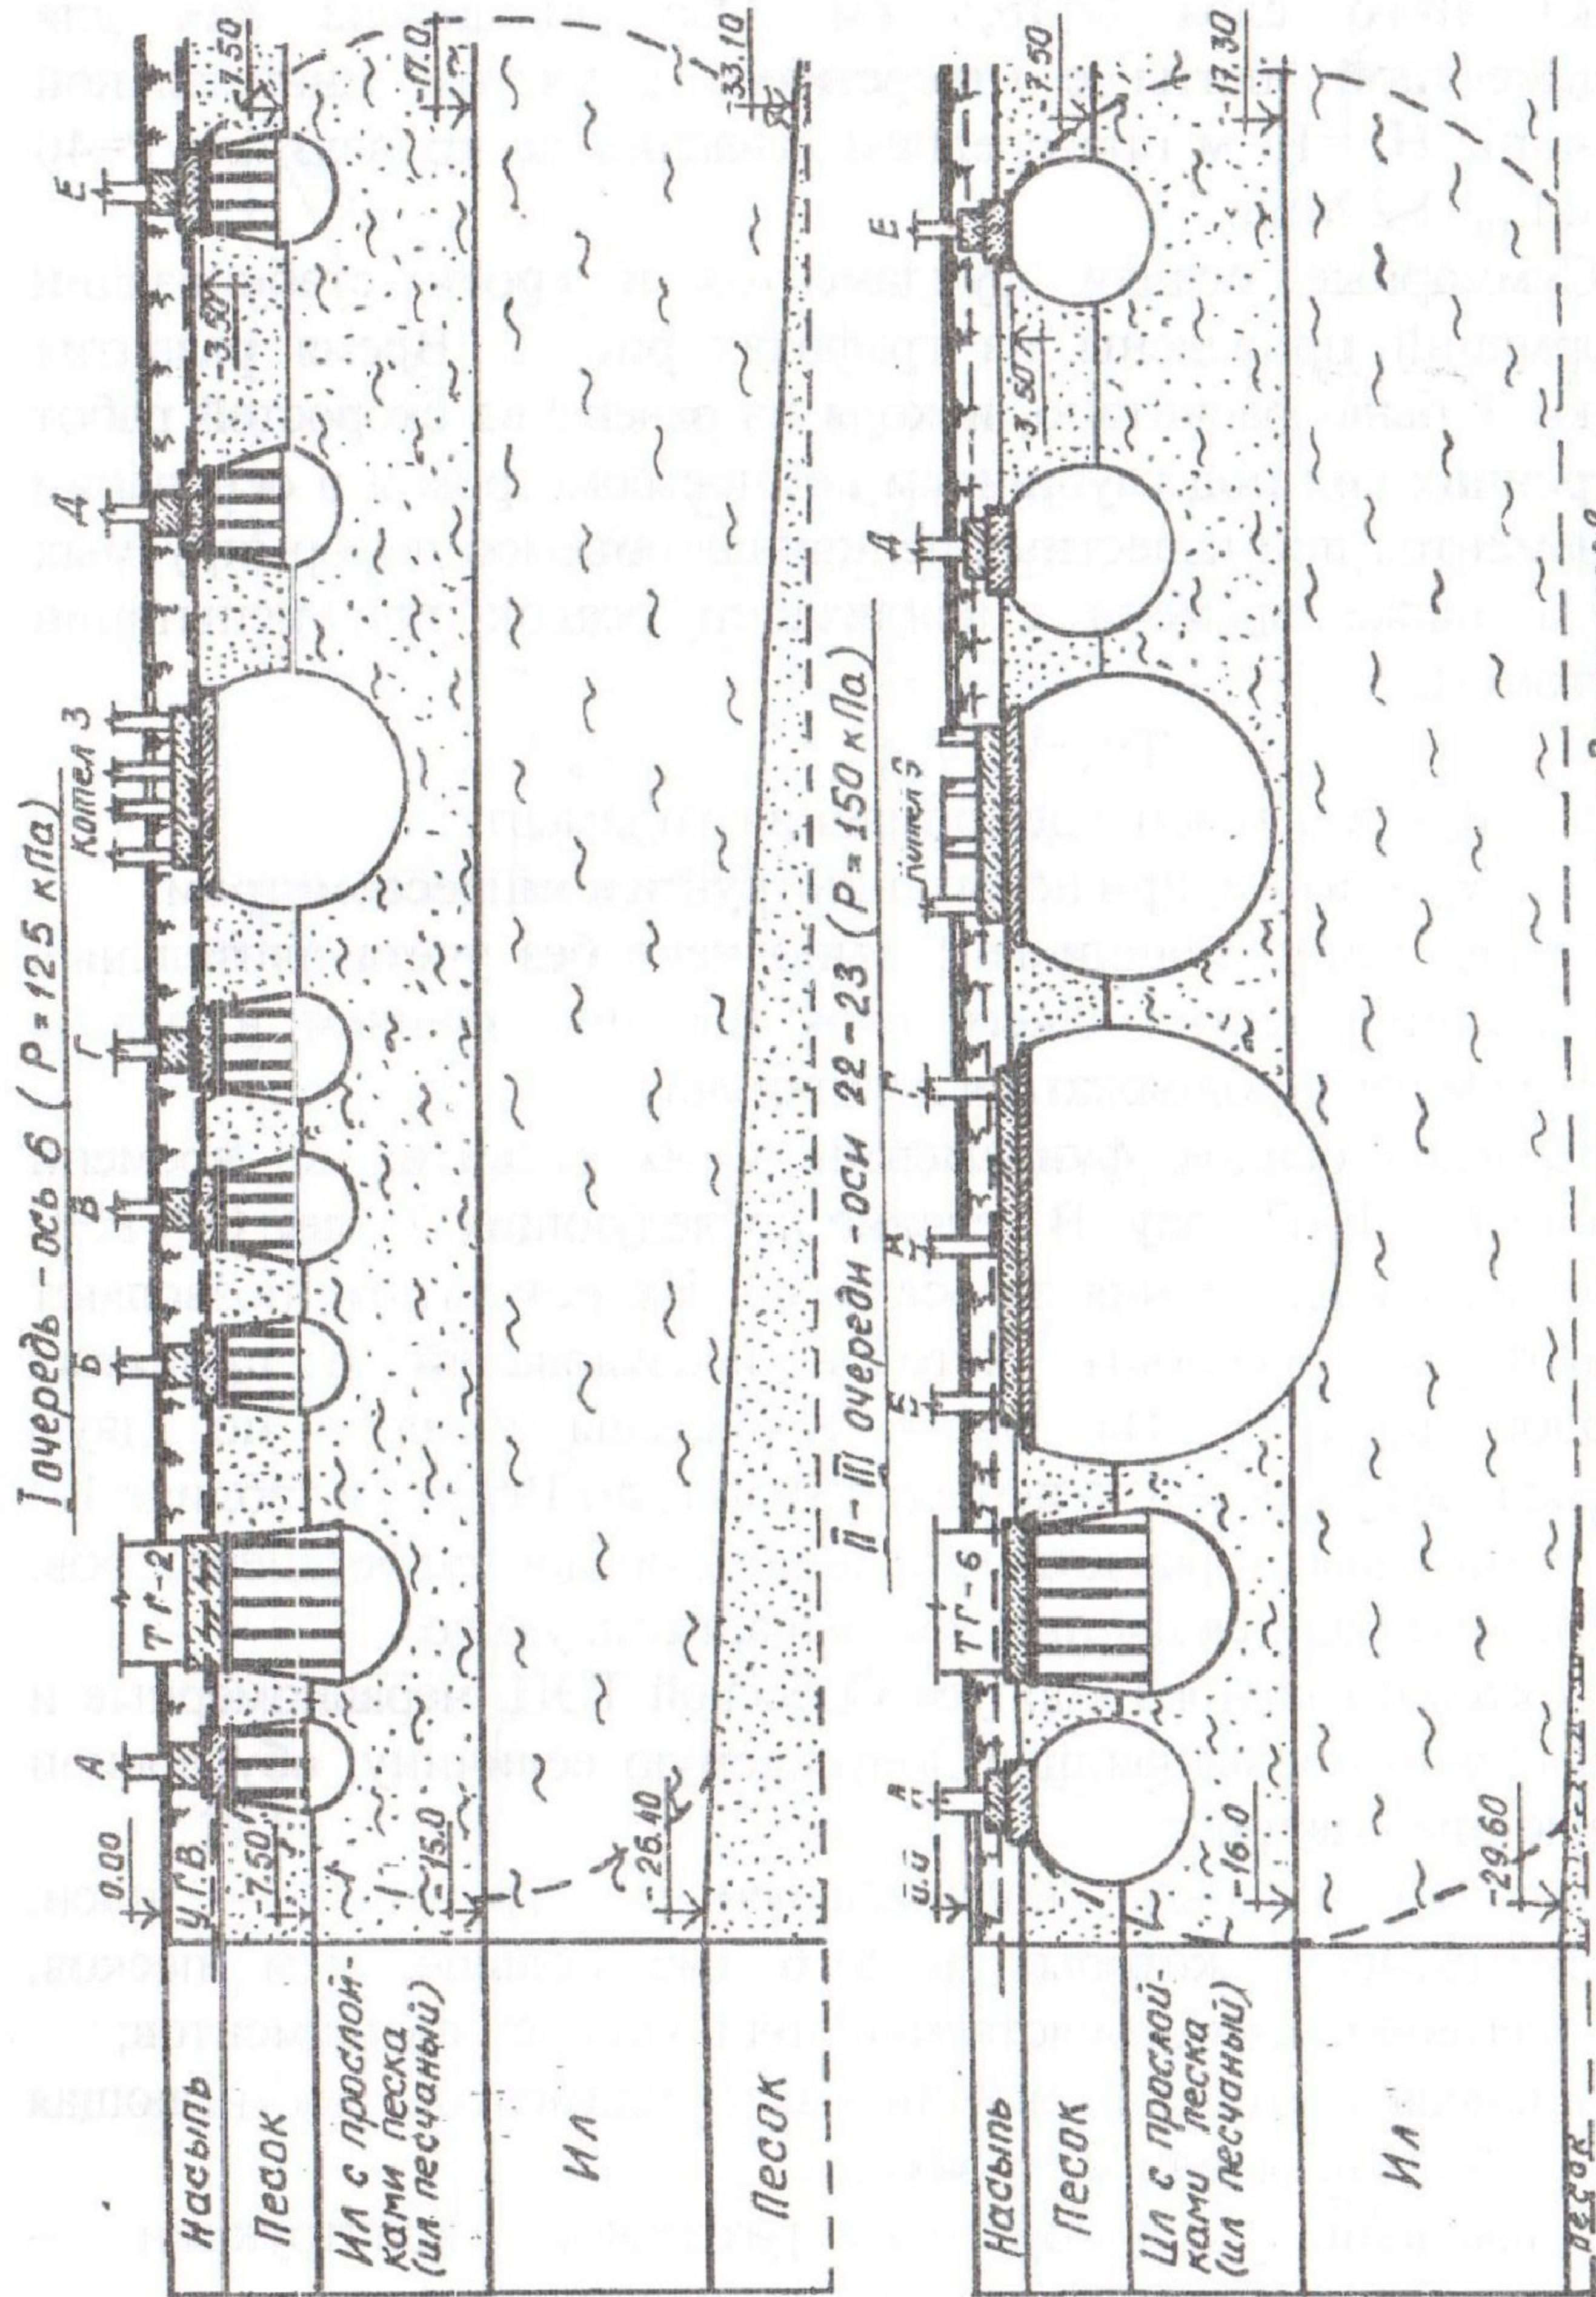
Разрезы основания и фундаментов, деформируемые зоны
